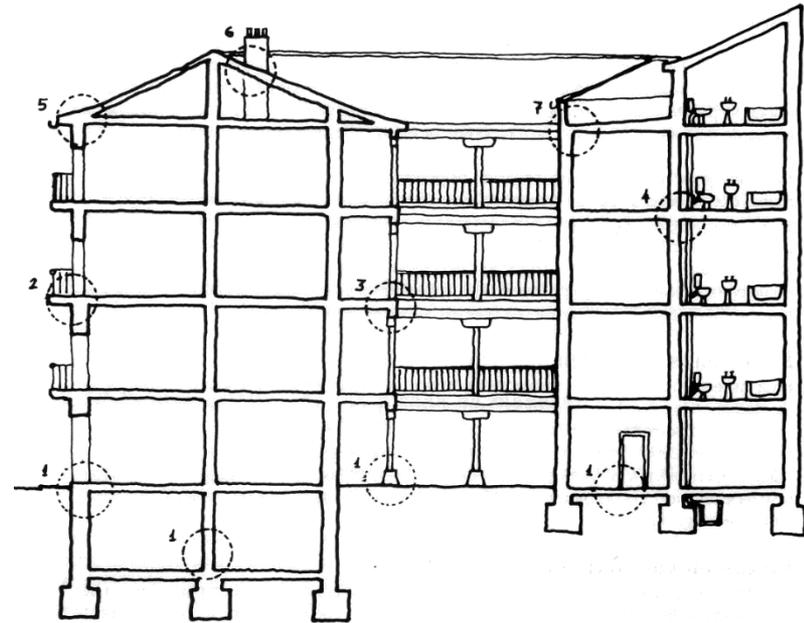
Zonas de riesgo en la construcción con madera: 1.- Piezas cercanas al suelo, 2.- apoyos de vigas en muros de fachada con repisa de balcones, 3.- Forjados de galerías, 4.- Forjados en locales húmedos, 5.- Aleros y encuentro de la cubierta con el muro, 6.- Paso de chimeneas en cubierta, 7.- Forjados con cubierta plana.
